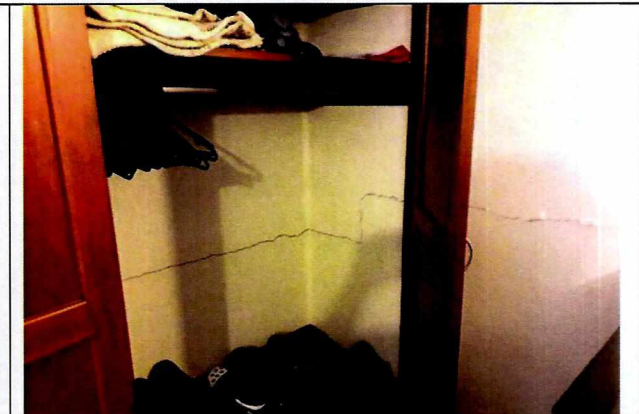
Fisura en muro interior – descanso de la escalera de acceso al segundo piso – 30 de enero de 2019
